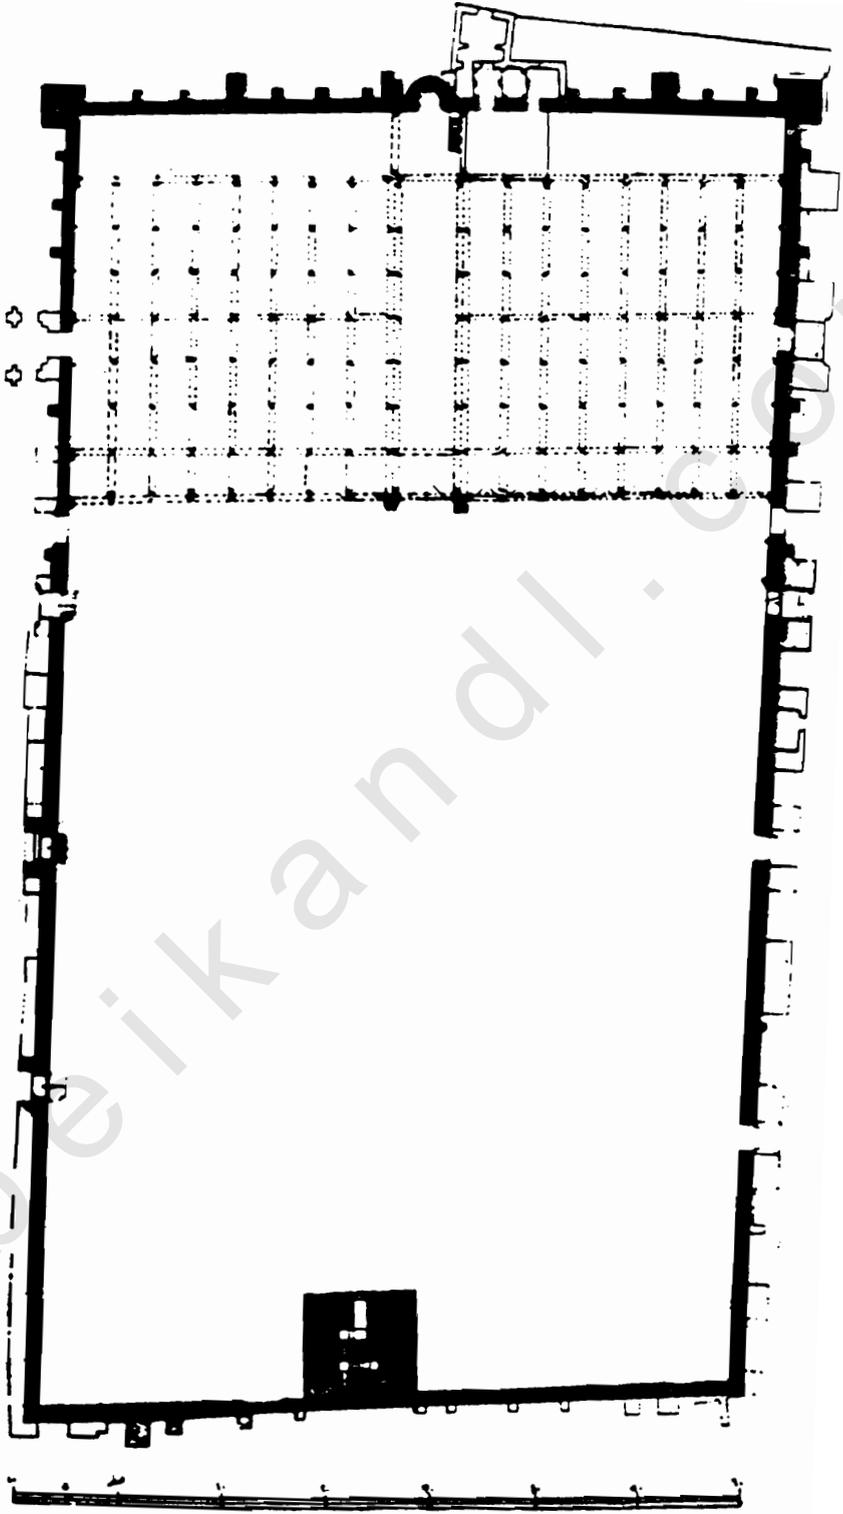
مسقط أفقي لجامع ابن صوان عن الموسوعة (الجزء الأول).
